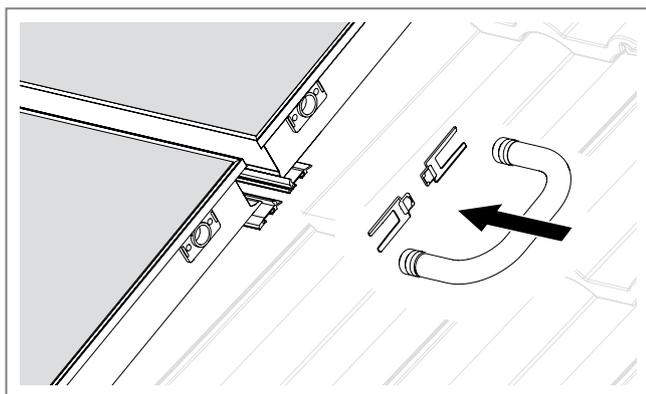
Collegamento dei collettori (disposizione a schiera con collettori)
